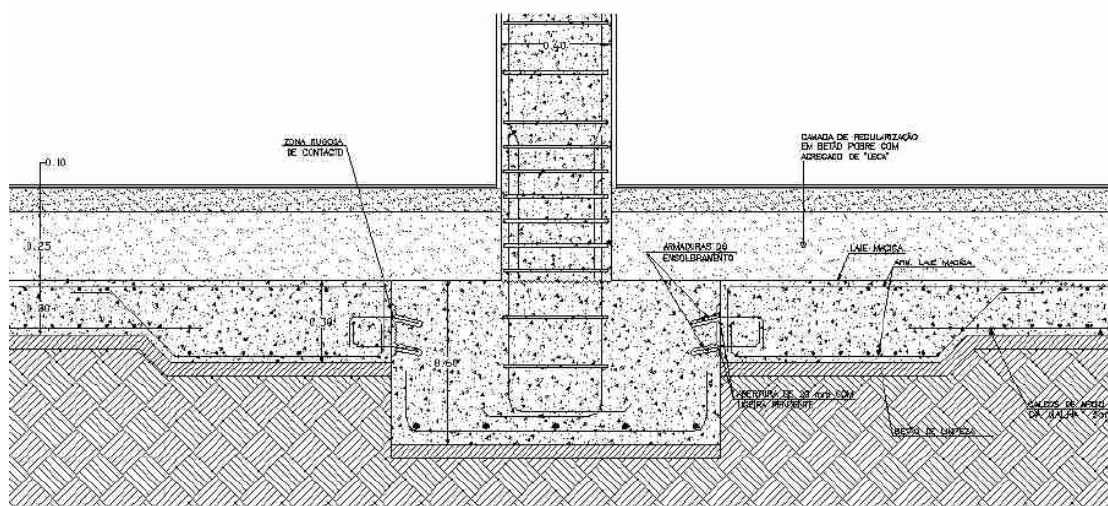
Pormenor da amarração de ensoleiramento às fundações do edifício.
